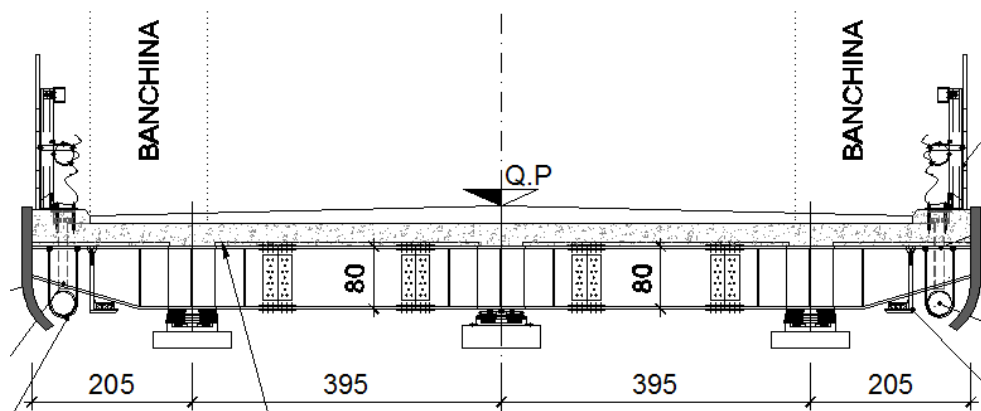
Sezione trasversale dell'impalcato campate laterali
